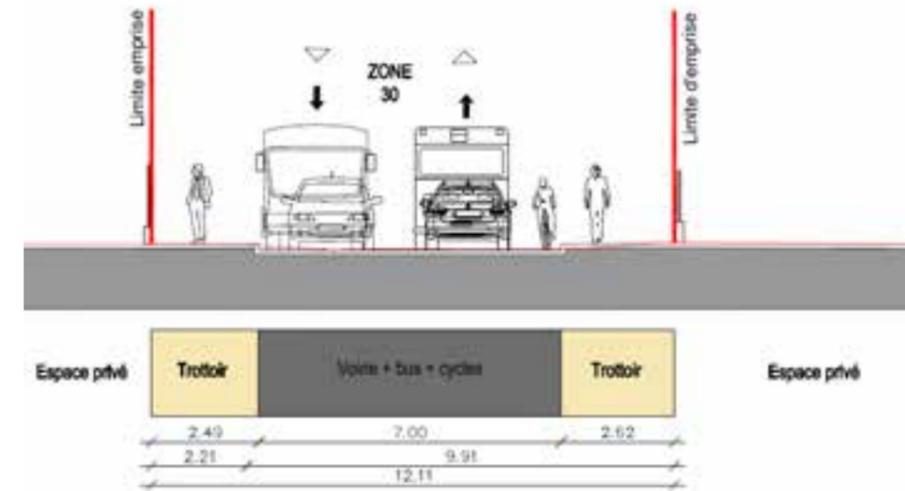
Coupe type en section courant sur la rue Henri Barbusse
